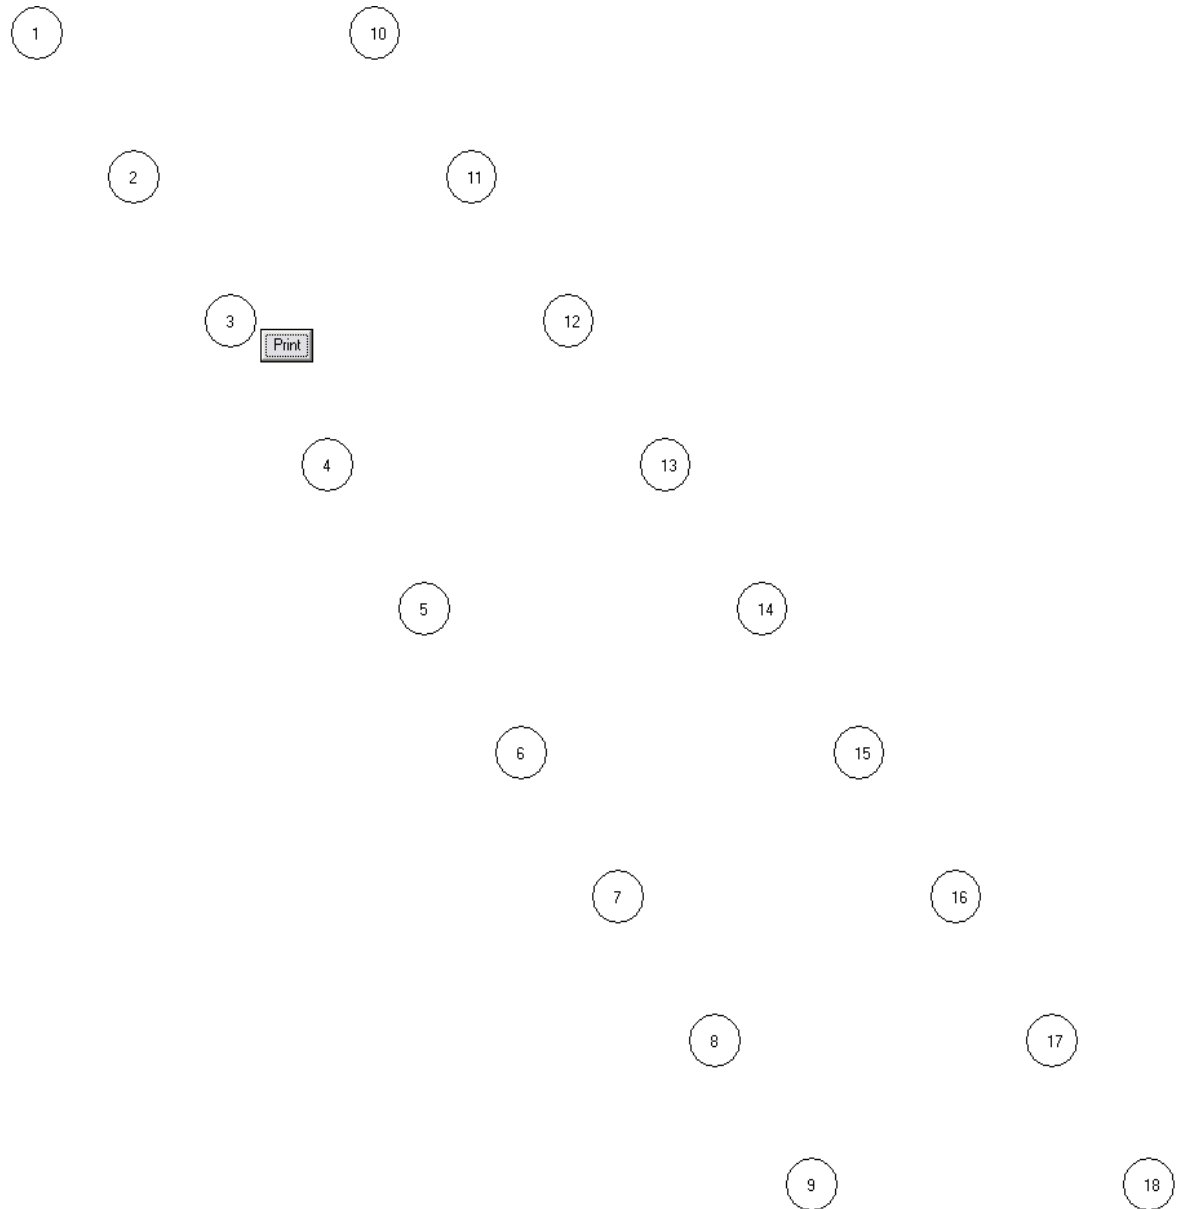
Schema Group della palificata (1/2 spalla) - fondazione esistente (pali Franki)
